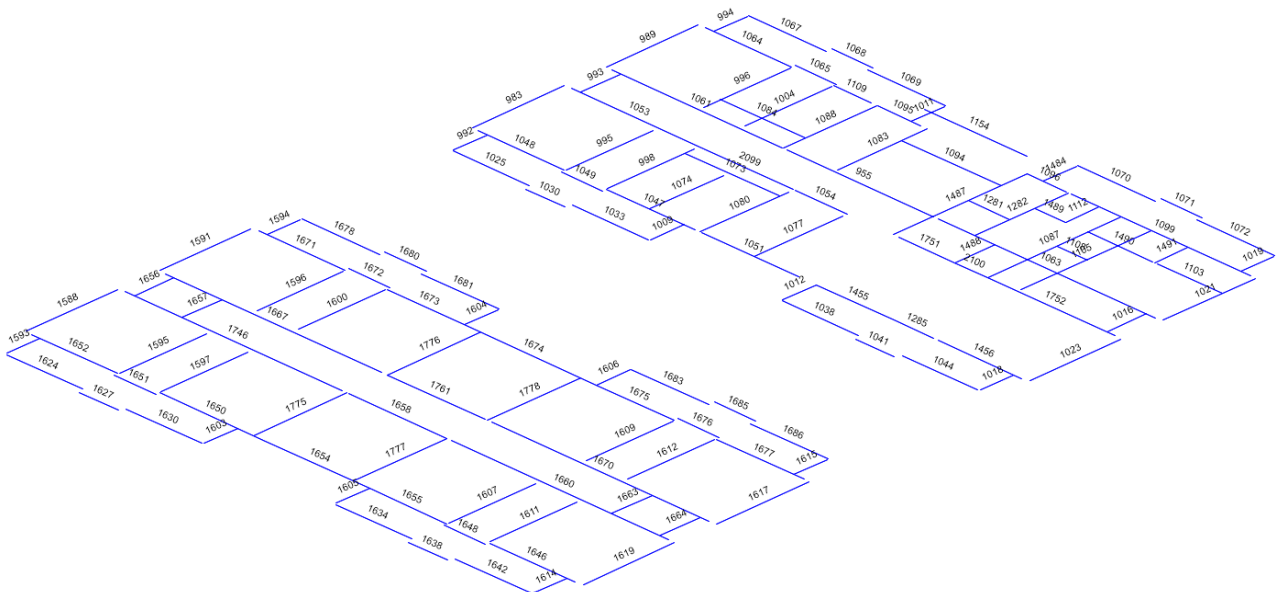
Nomes 'Frames' - Vigas cobertura
